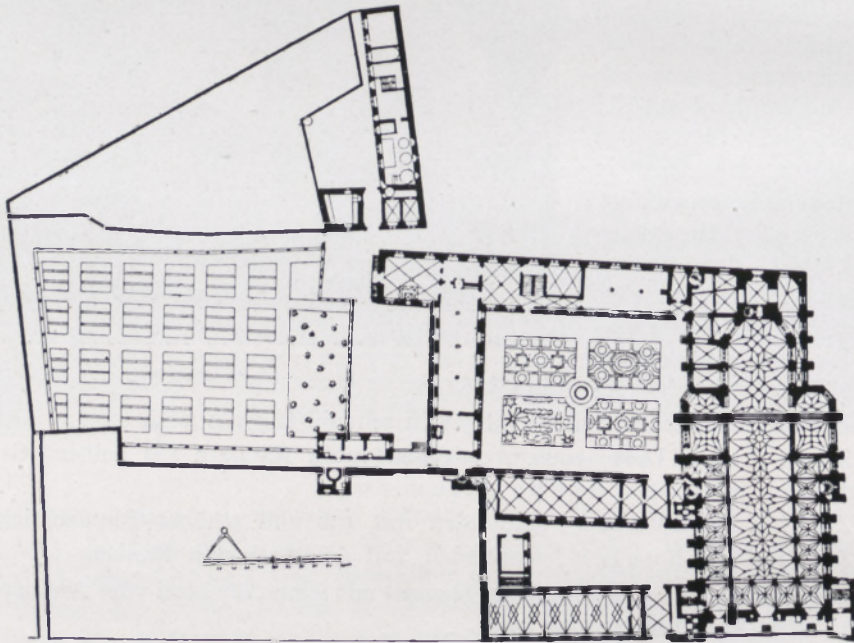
Grundriss des ehem. Jesuitenkollegs, nach einer Zeichnung des 17. Jh.
